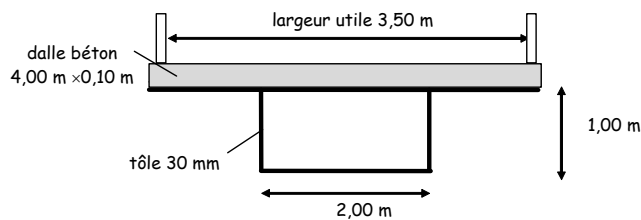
Section transversale de la passerelle à caisson mixte
